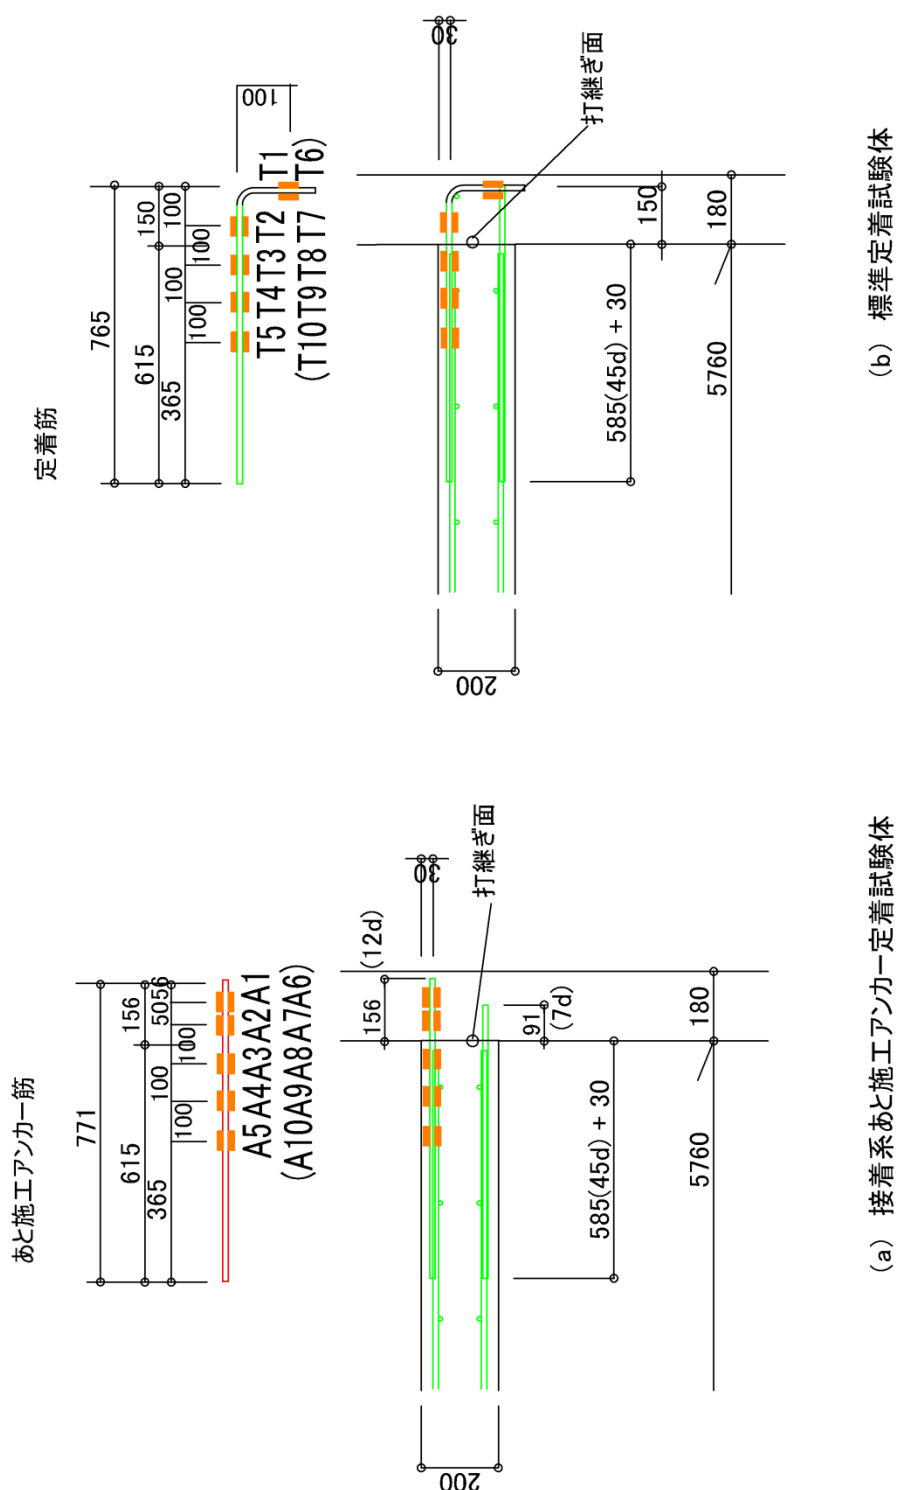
鉄筋(あと施工アンカー筋, 定着筋)ひずみ測定位置図
